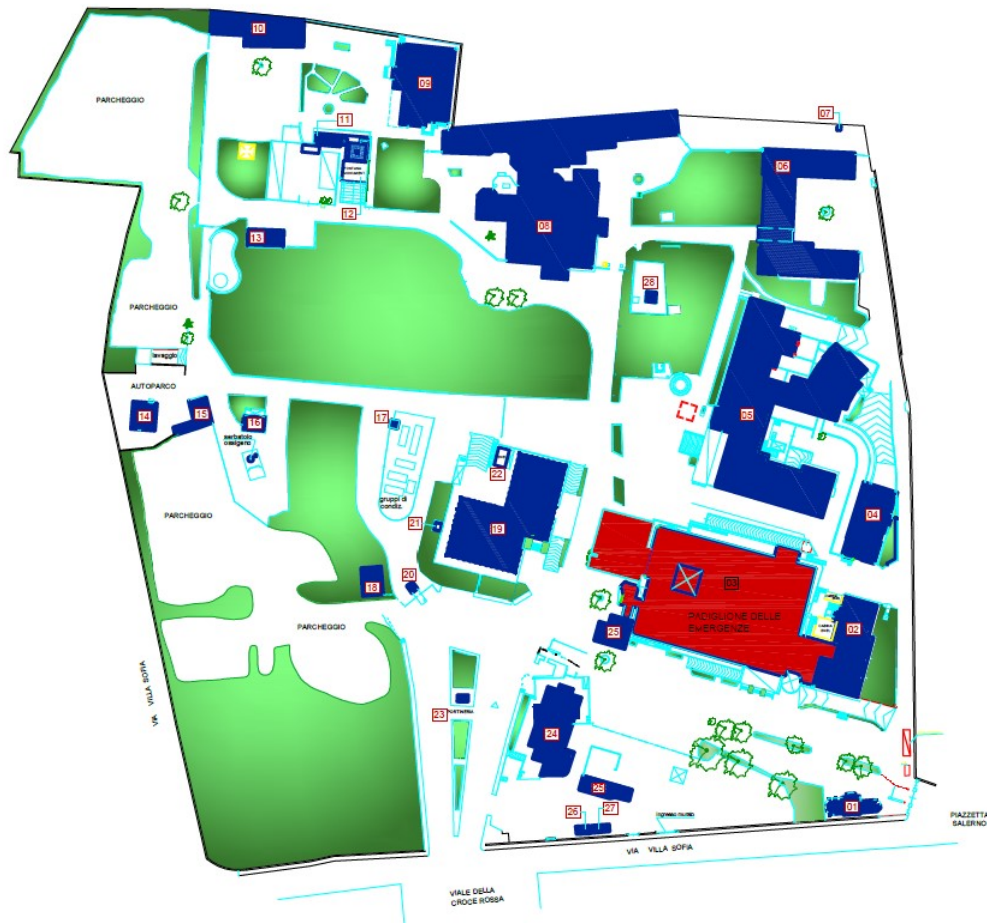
Planimetria generale del P.O. “Villa Sofia”
